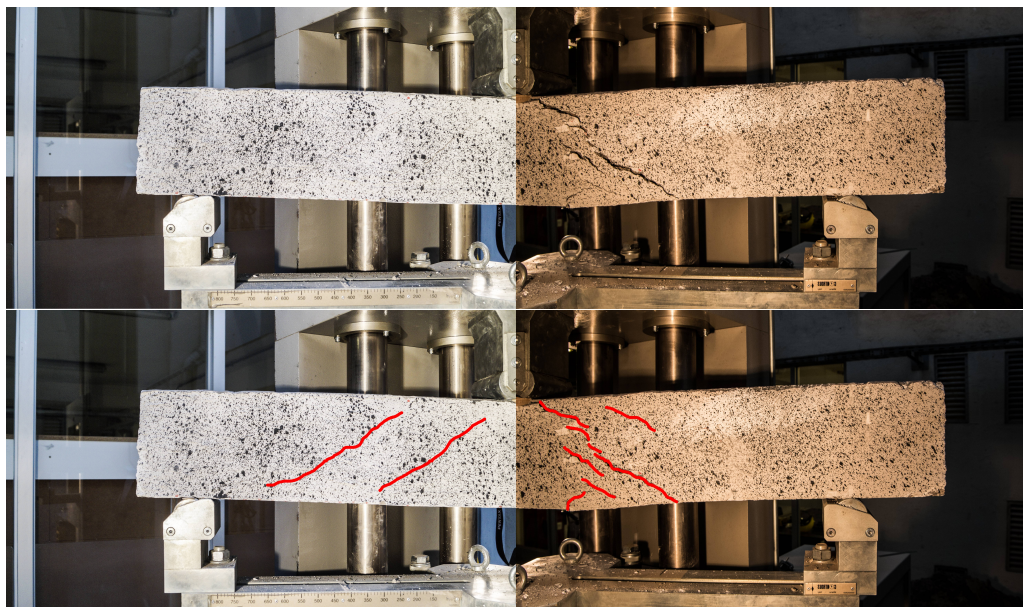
Agrietamiento en la viga 1 al finalizar el ensayo de carga deformación.
